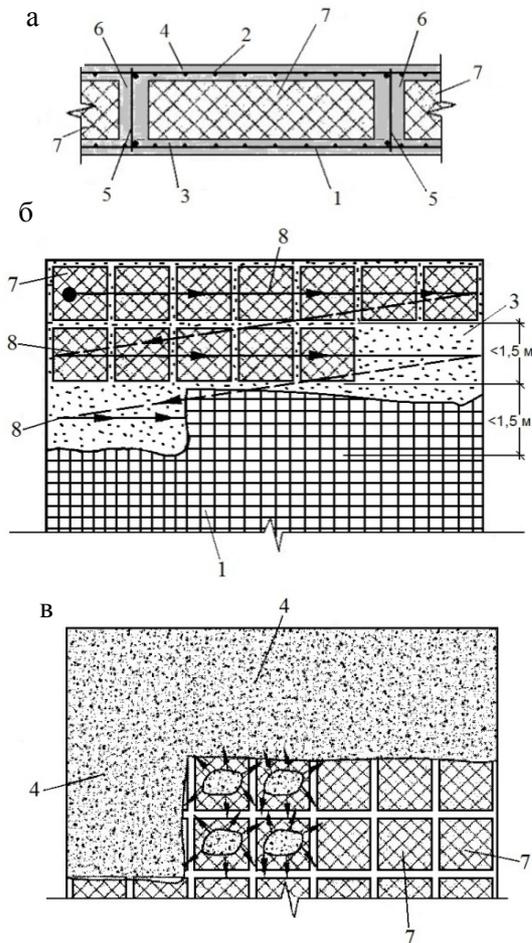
Способ устройства облегченного железобетонного перекрытия: а – поперечное сечение перекрытия; б и в – последовательность бетонирования перекрытия; 1 и 2 – арматура нижней и верхней сетки; 3 и 4 – нижняя и верхняя обшивка; 5 – арматурные каркасы; 6 – ребра перекрытия; 7 – вкладыши; 8 – направление бетонирования нижней обшивки перекрытия
